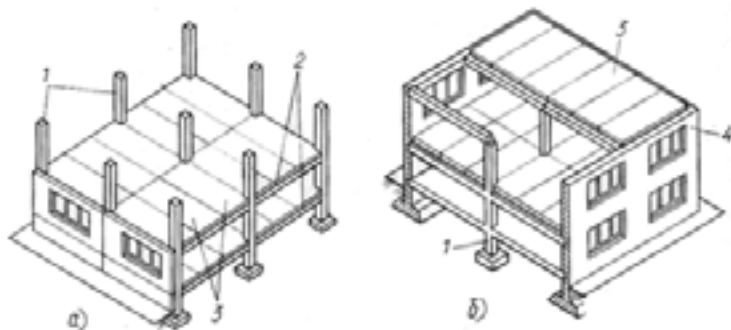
Конструктивные схемы зданий: а – с полным каркасом, б – с неполным каркасом; 1 – колонны, 2 – ригели, 3 – панели перекрытий, 4 – несущие наружные стены
